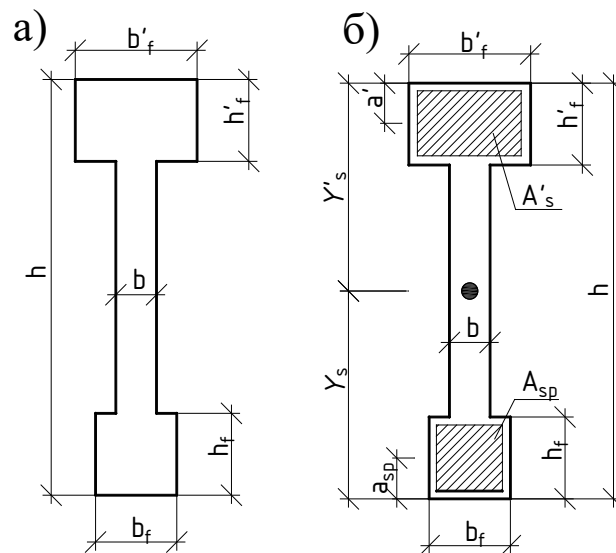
Схемы расчетного (а) и приведенного (б) сечений балки
